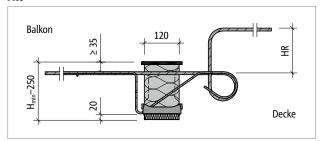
Schöck Isokorb® XT Typ K-HV: Produktschnitt
